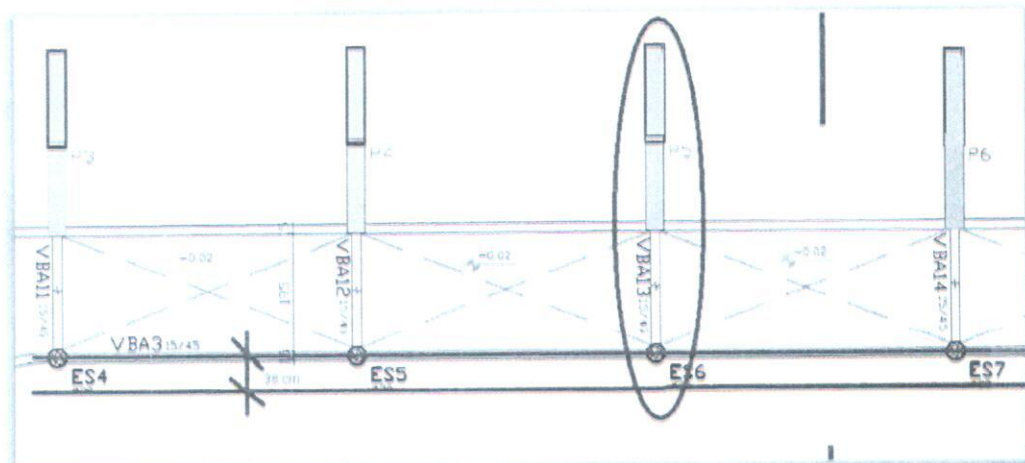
VIGA VBA 13 EM PLANTA APÓS DESLOCAMENTO DA ESTACA
